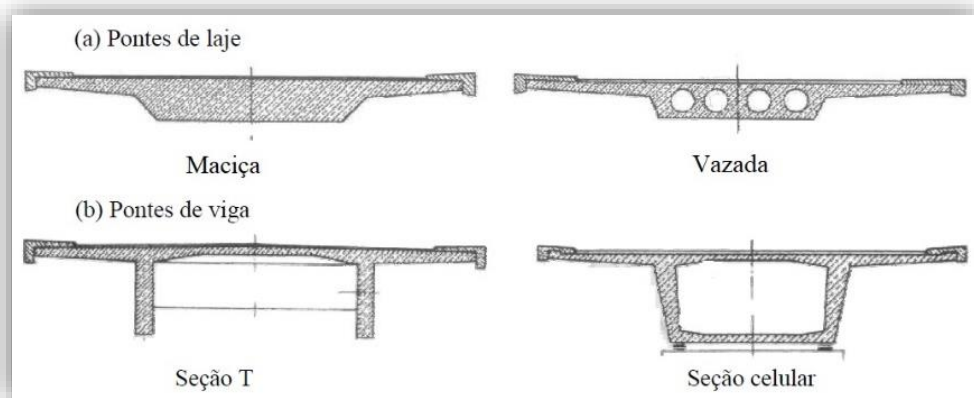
Seções transversais das pontes de concreto. Fonte: Debs & Takeya. (modificado).
